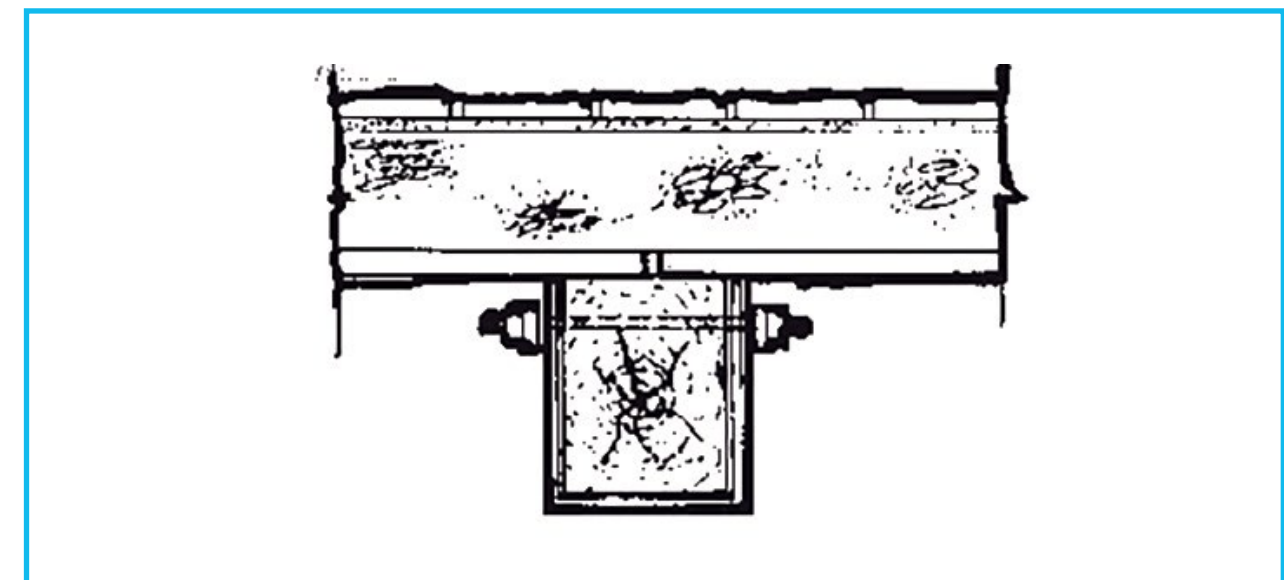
Refuerzo mediante fleje metálico que rodea a la viga de madera agrietada y pernos
